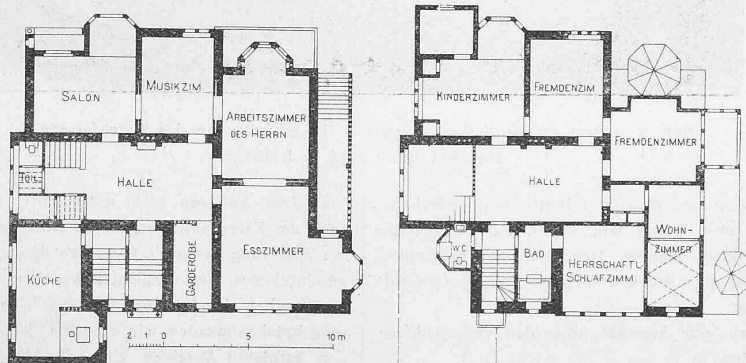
Villa Castenholz in Koblenz. — Grundrisse vom Erdgeschoss und I. Obergeschoss.
